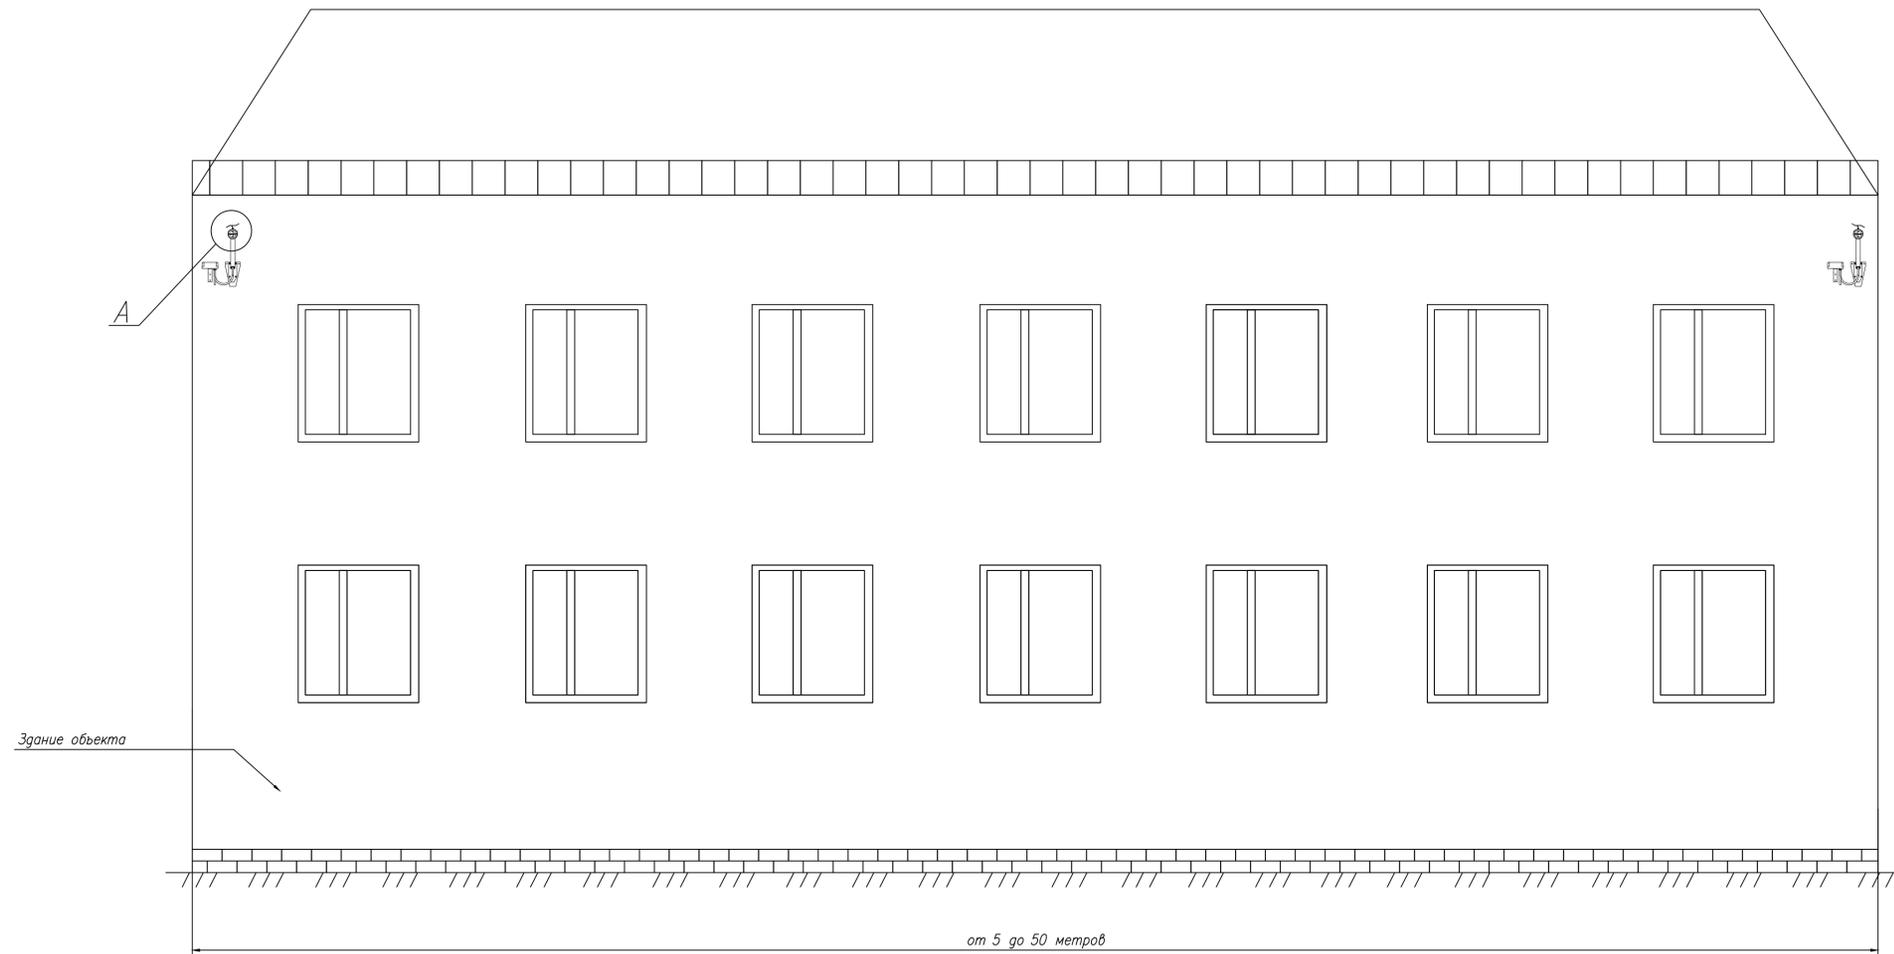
Установка ПРМ, ПРД на стене здания
